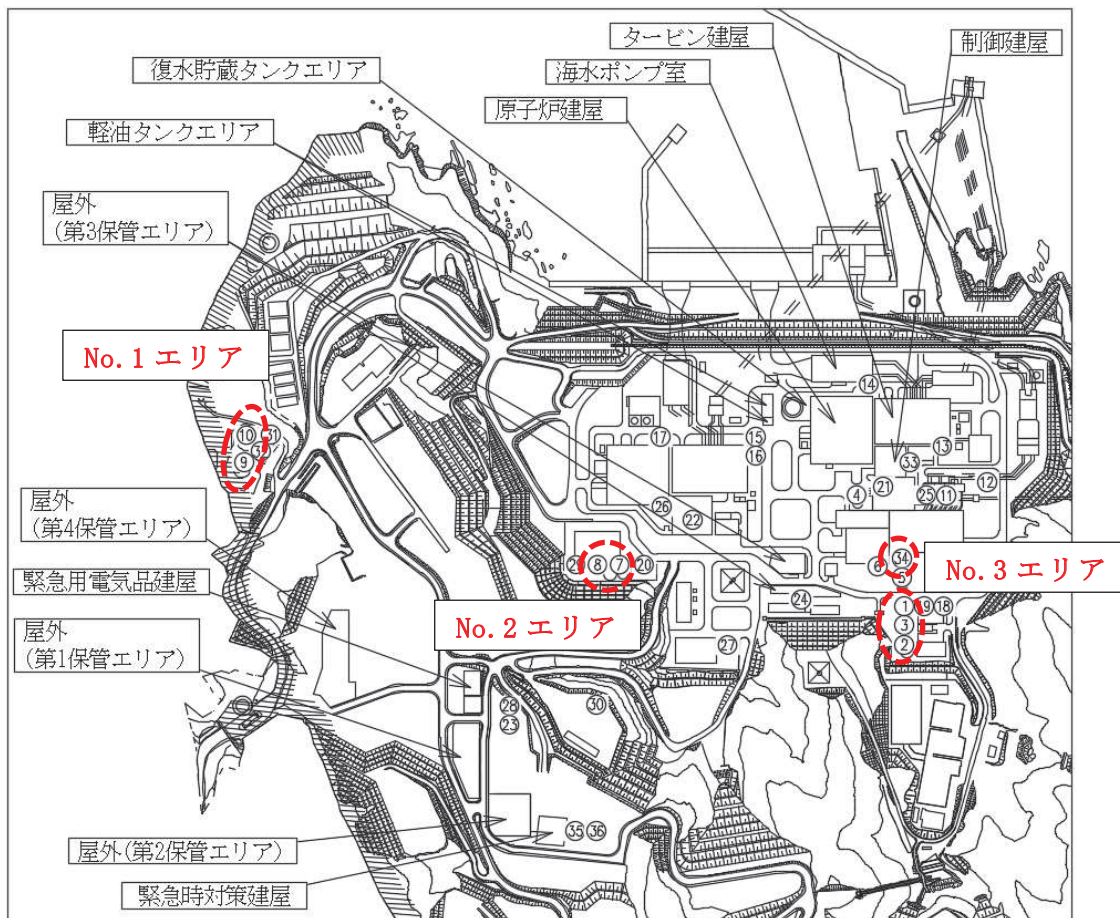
溢水影響評価の対象となる屋外タンク配置図
